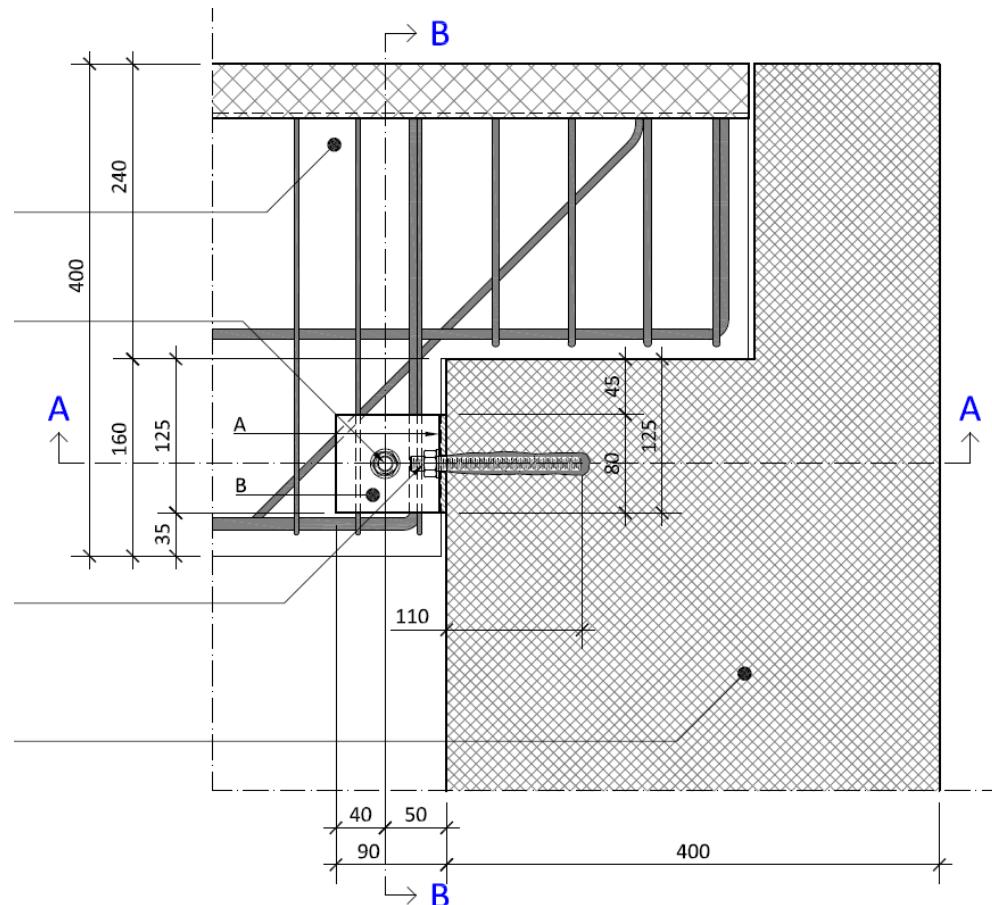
Intervento 01b – Sezione parallela ai tegoli
